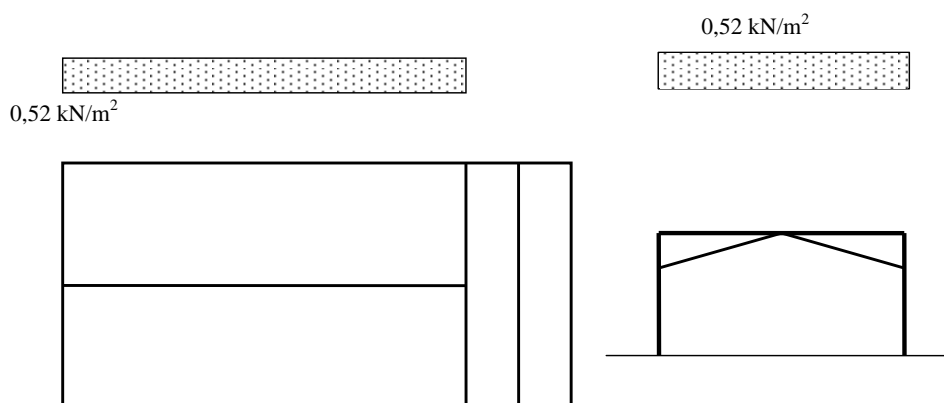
Charge de neige sur la toiture inférieure en l'absence d'accumulation et en situation de projet durable
